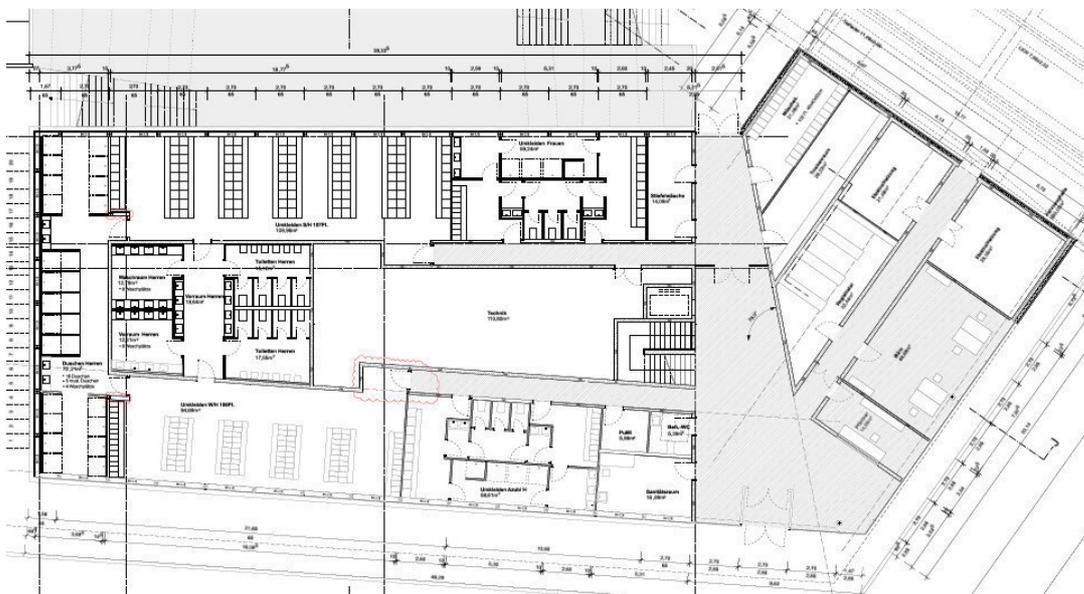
B1 Grundriss Erdgeschoss
